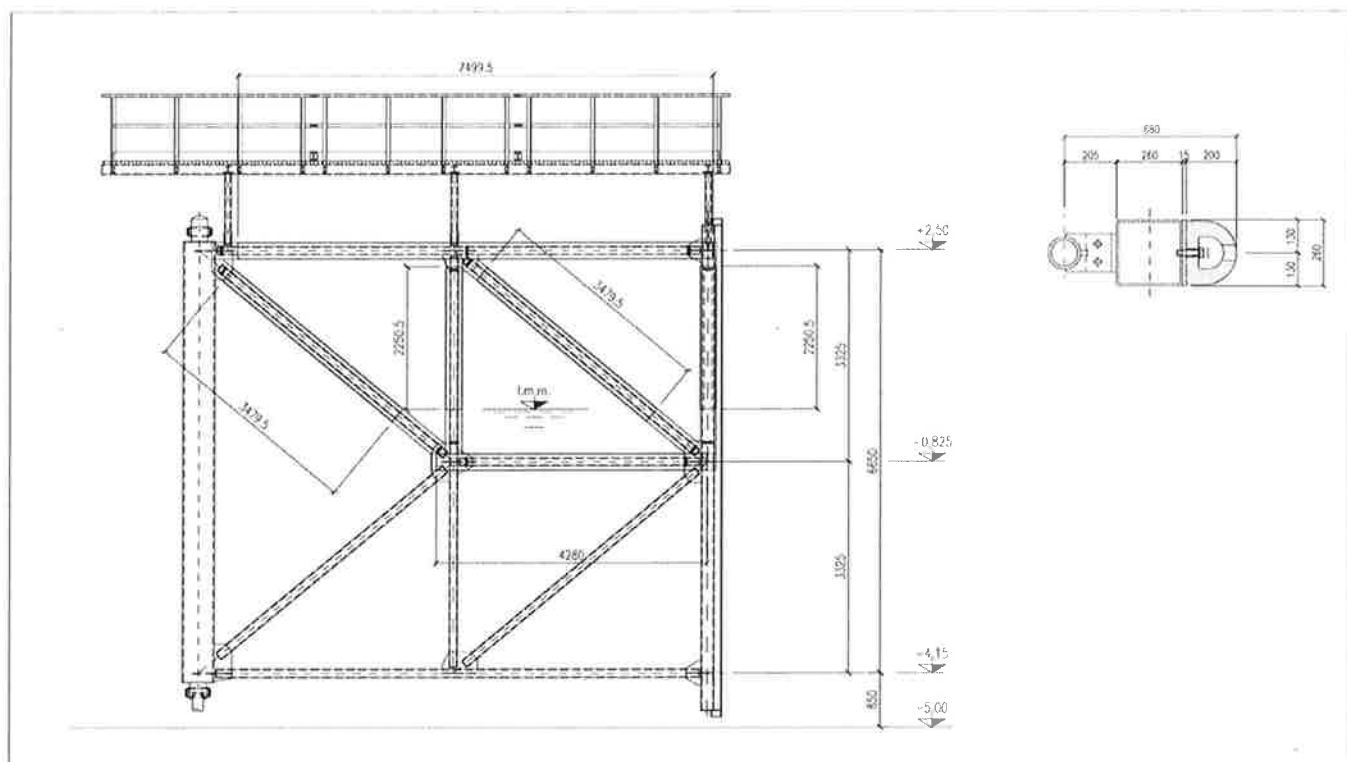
ELEMENTO FENDER E TELAIO REGGI - FENDERS
